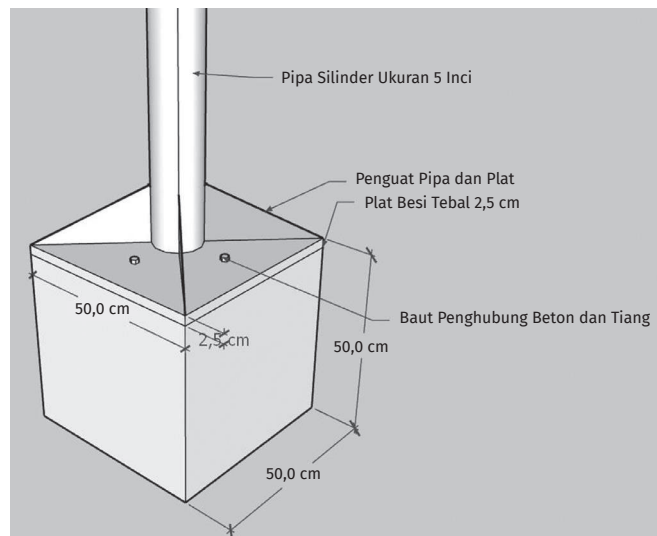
Rancangan Fondasi PLTB 1.500 Watt
